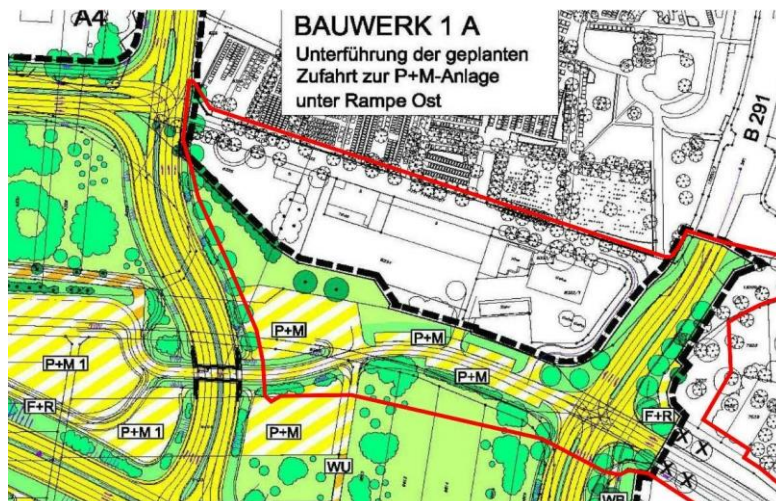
Bebauungsplan „Südumgehung, 1. Änderung“ (Ausschnitt mit Plangebiet)
